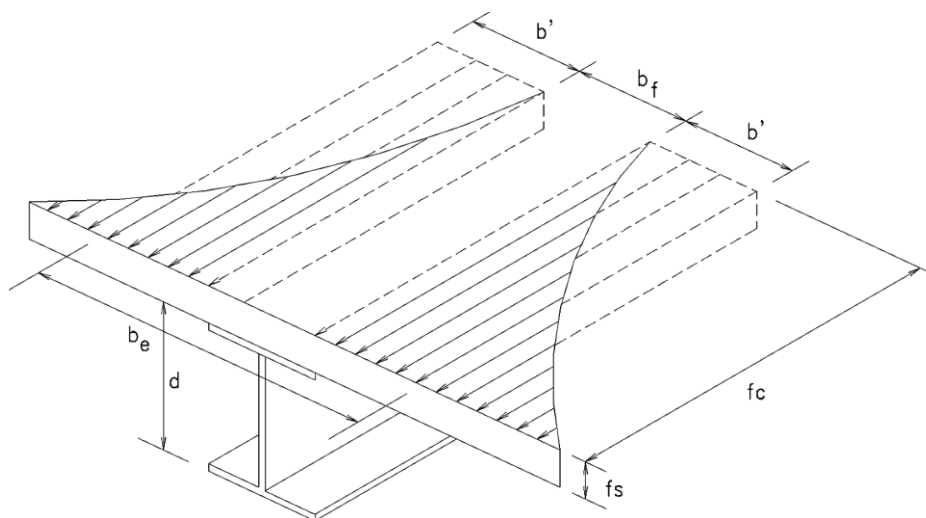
Ancho efectivo colaborante en la construcción compuesta.
